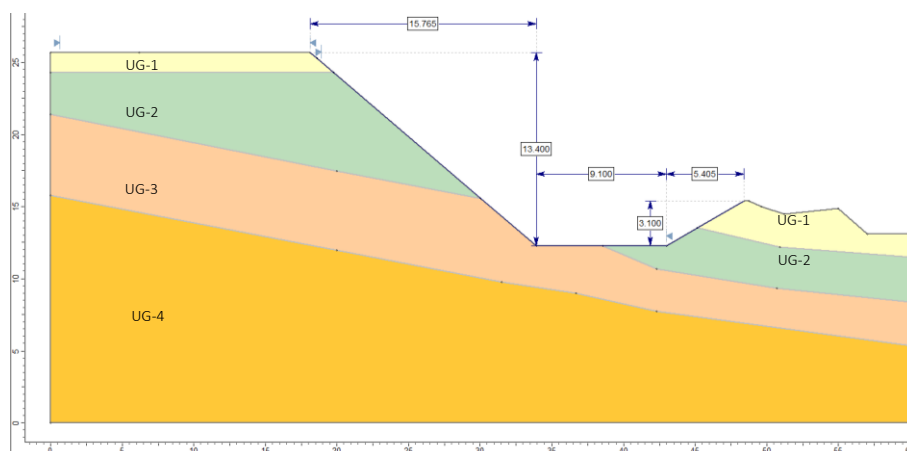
Excavación propuesta para el proceso constructivo del muro de suelo reforzado.
